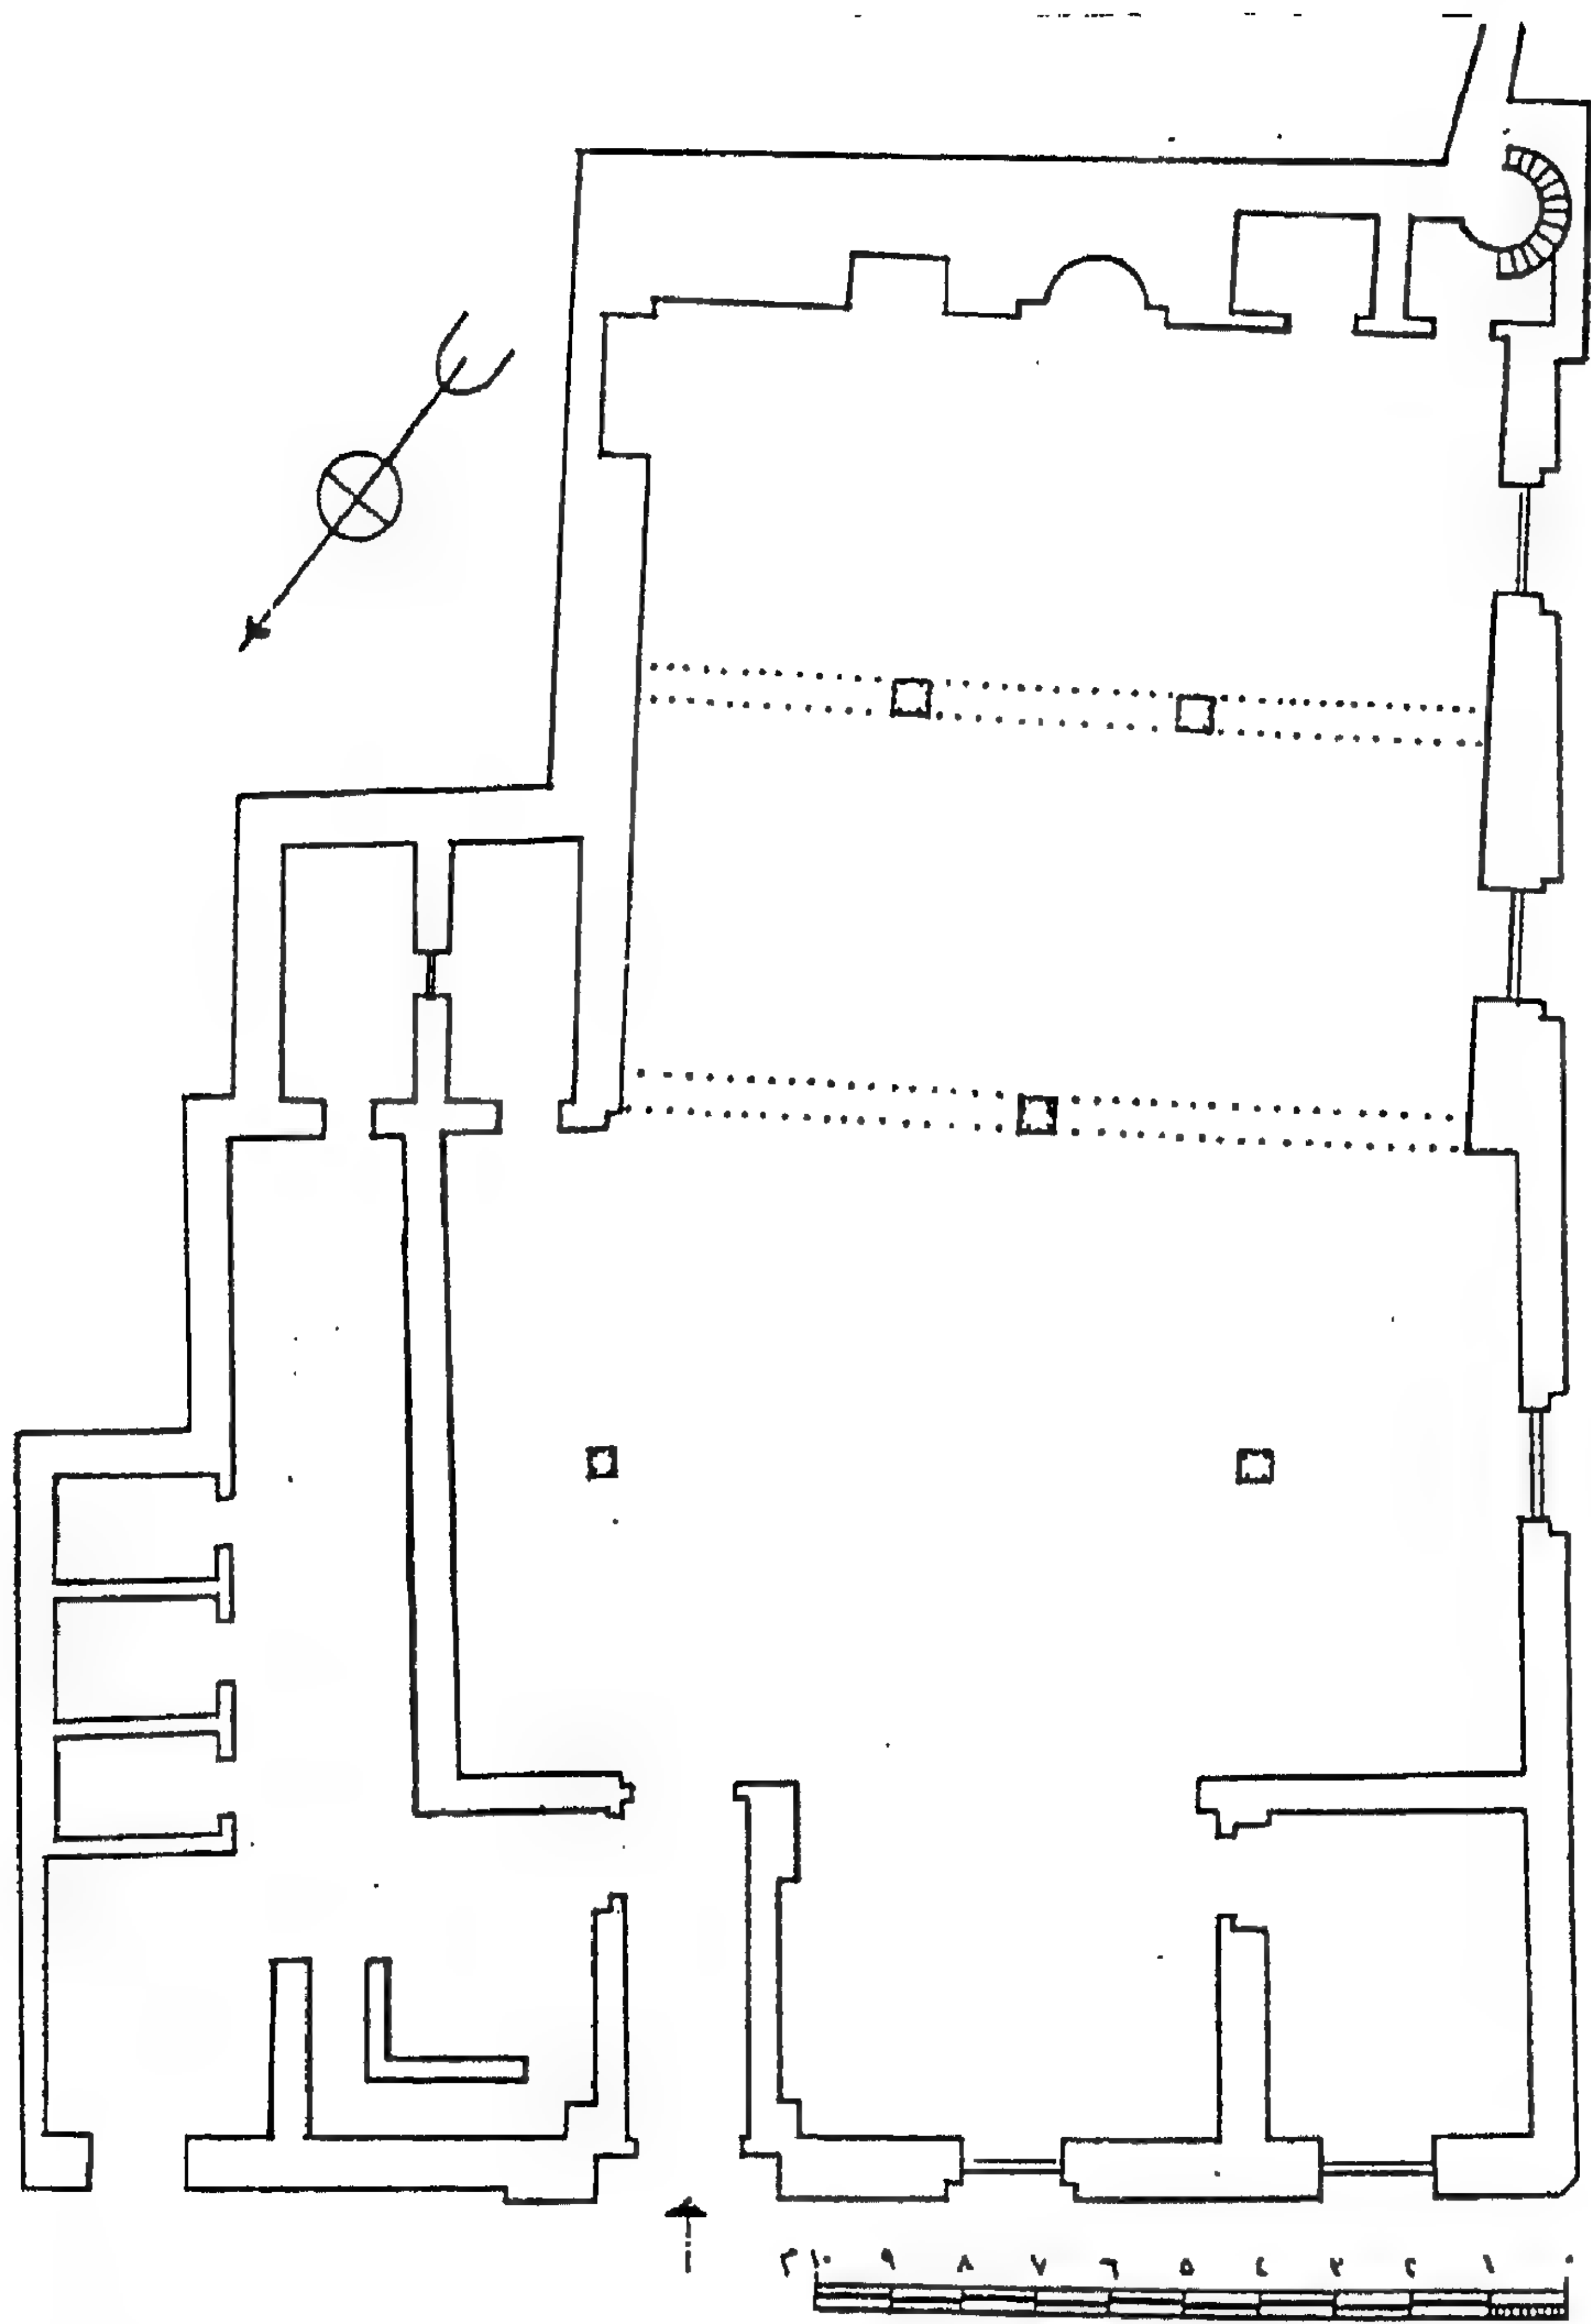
مسقط أفقى لجامع عقبة بن عامر بقرافة الإمام الليث بن سعد.
